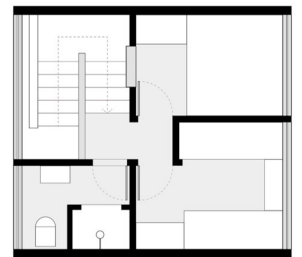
Planta Baixa modificada Residencial Paquetá
